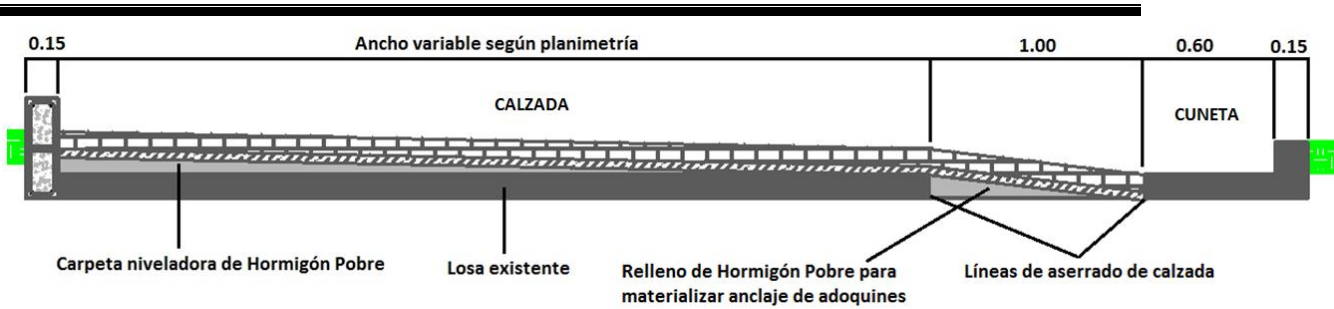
Perfil Tipo T 2 utilizado para el cómputo de Hormigón Pobre
